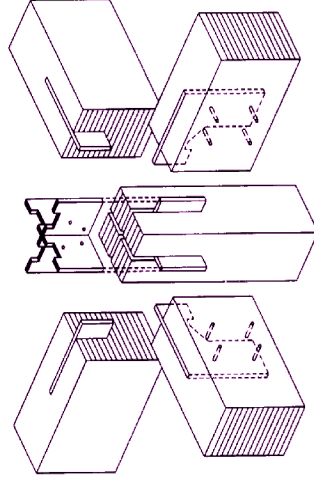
Sistema de unión entre pilares y vigas de madera laminada, patentado como JANEBO (Bulldog-Simpson). Presenta la ventaja de quedar oculto, con un comportamiento al fuego mejor y permite un rápido montaje en obra.
